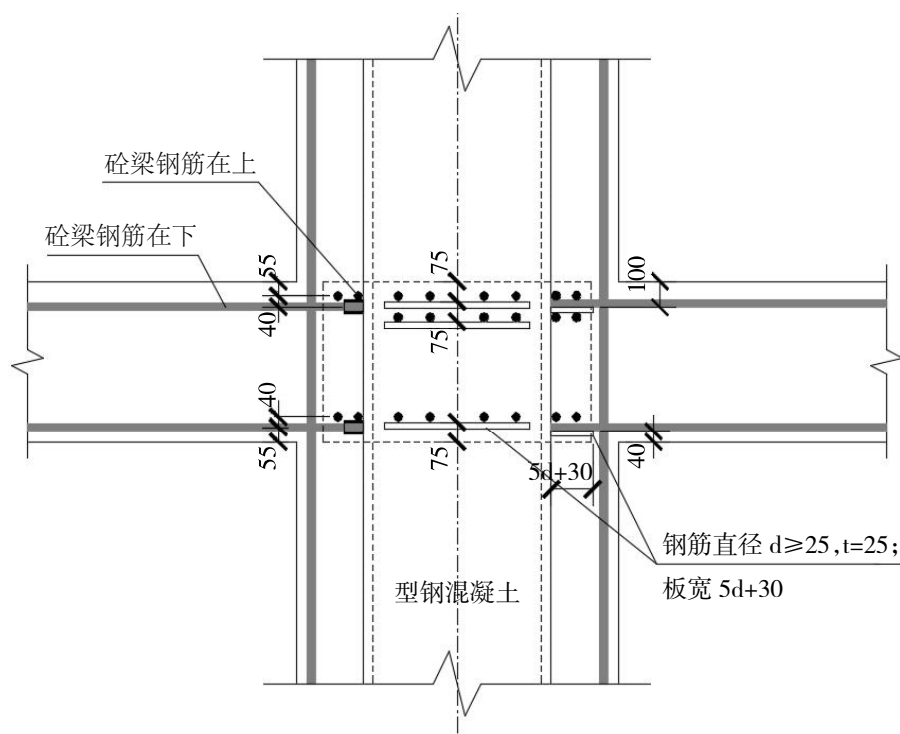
钢筋混凝土梁与型钢混凝土柱相连节点
